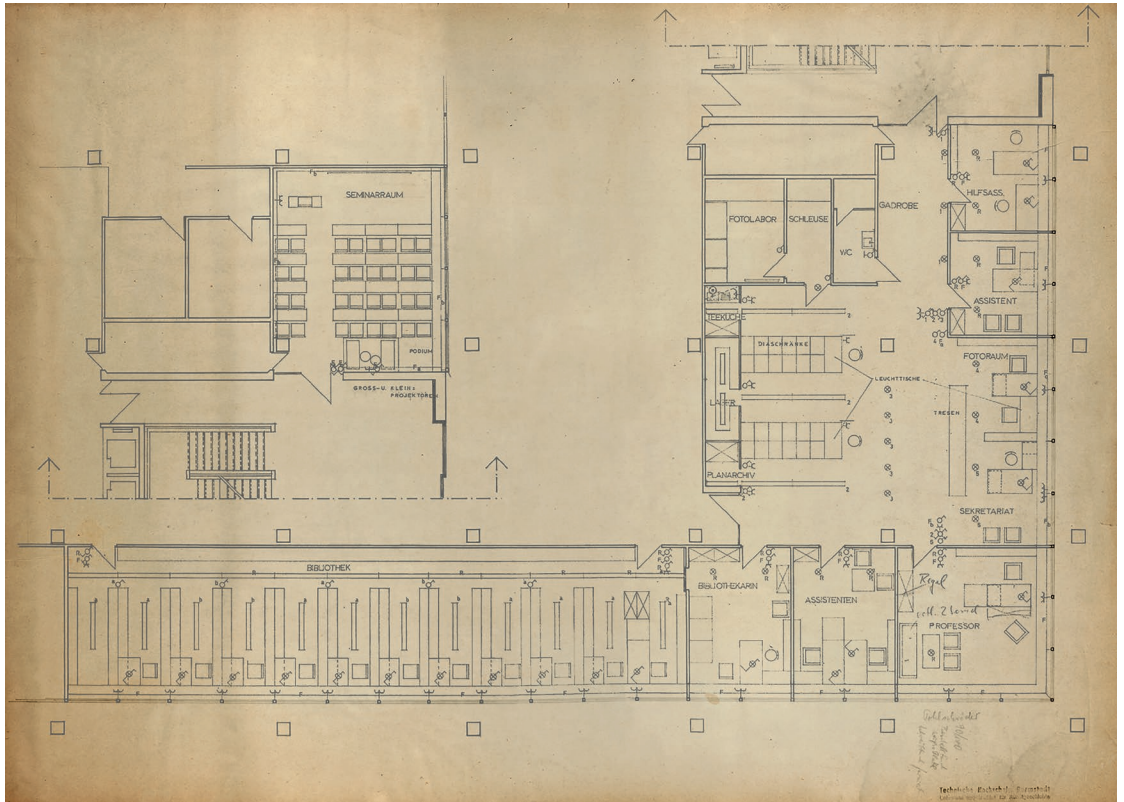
Grundriss Lehrstuhl Kunstgeschichte, Neubau Fachbereich Architektur der TU Darmstadt, ca.1969, Sammlung Fachgebiet Architektur- und Kunstgeschichte, TU Darmstadt.
